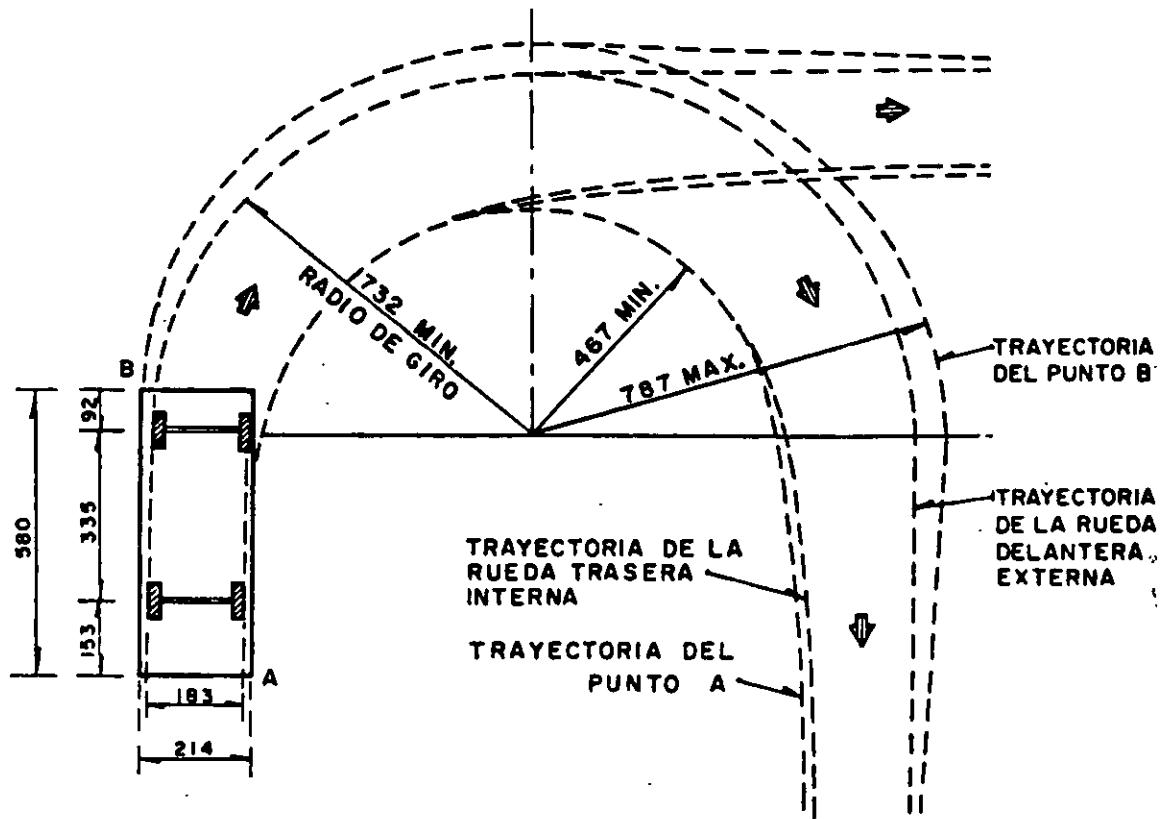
CARACTERÍSTICAS DEL VEHICULO DE PROYECTO DE 335
